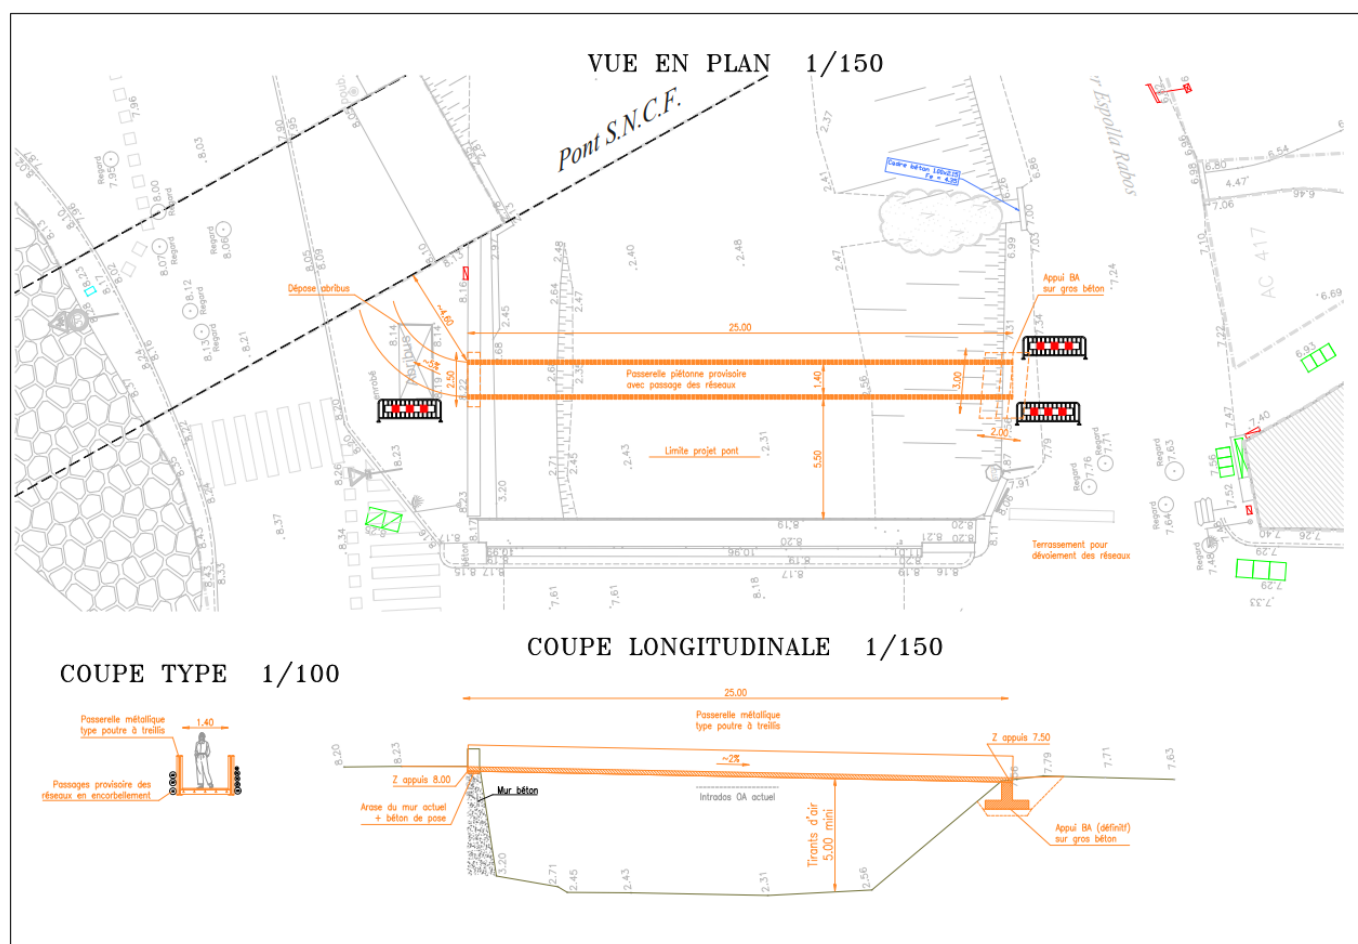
Vue en plan et coupe longitudinale de la passerelle provisoire (source : SEDOA, DCE, mai 2025)
